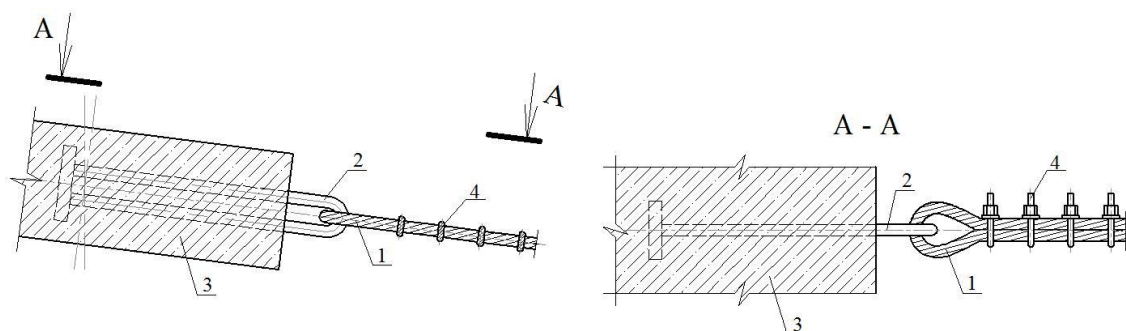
Крепление вант к наружному опорному контуру вантового покрытия с помощью закладной детали «петля»: 1 – вант (стальной трос); 2 – закладная деталь (ЗД) в виде петли; 3 – наружный железобетонный опорный контур; 4 – хомут
